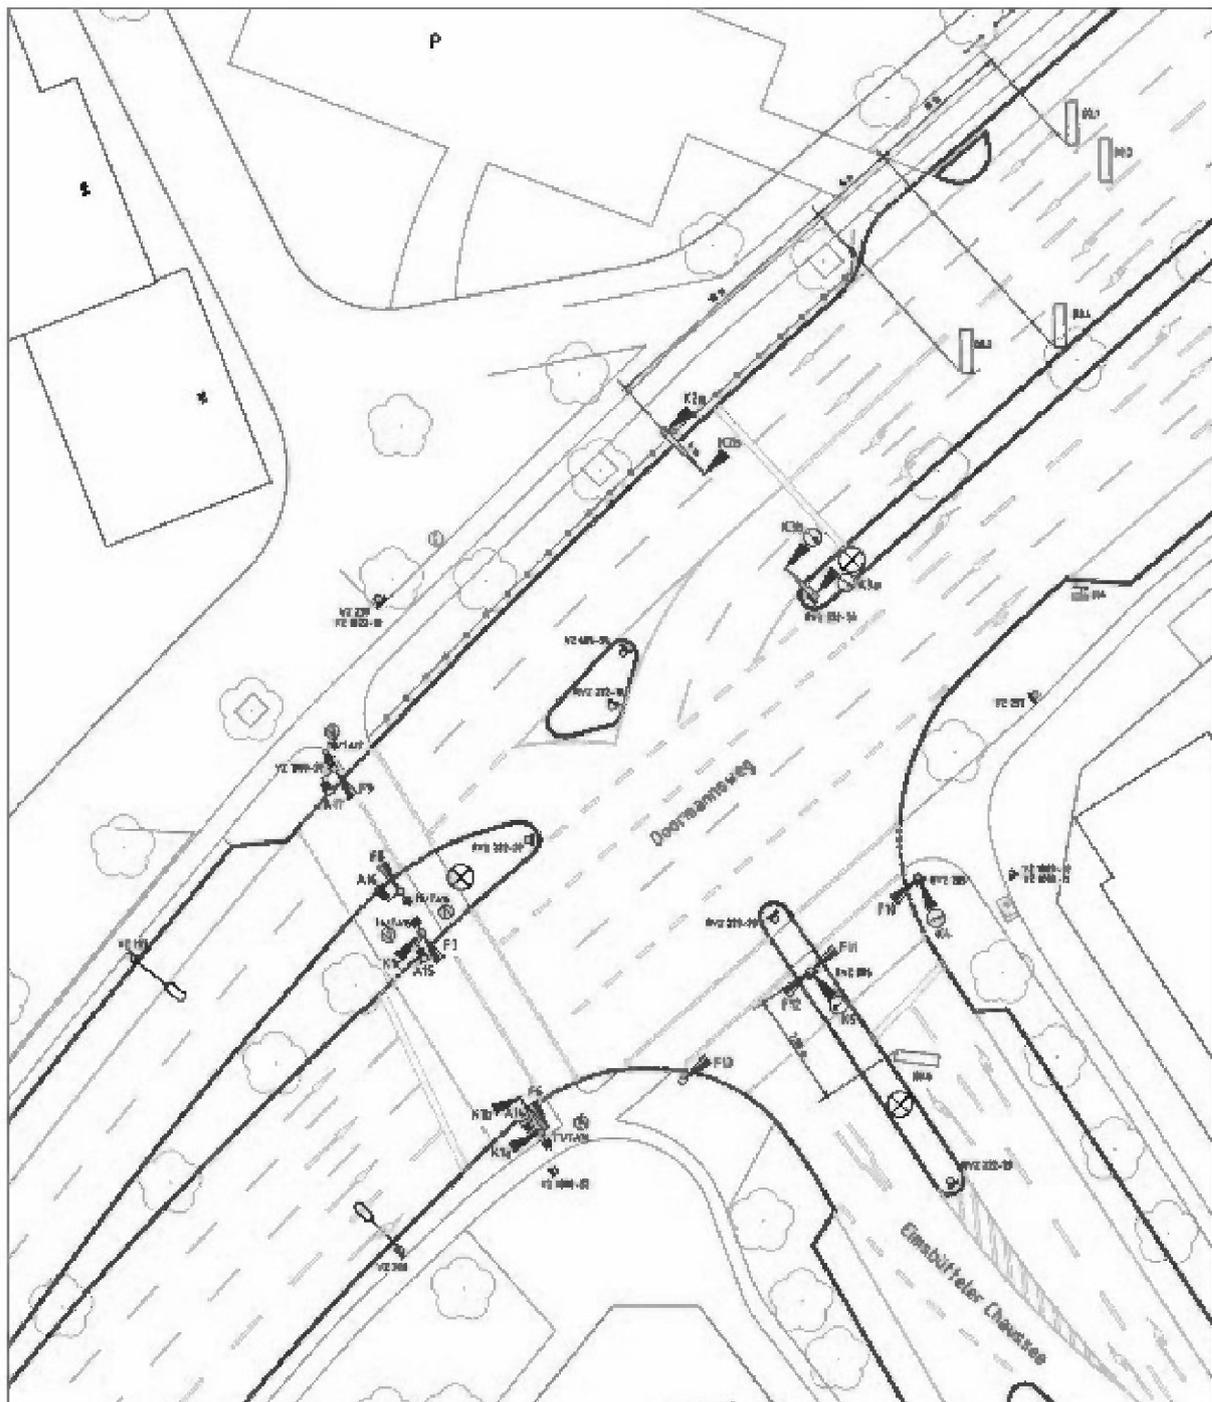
2 Signallageplanausschnitt LSA 941
